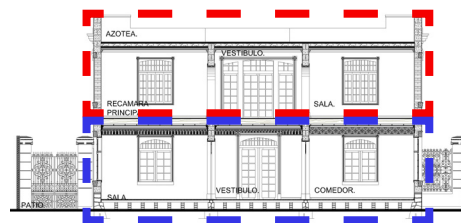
, corte longitudinal de Orizaba 146. En el nivel de planta baja se concentran todos los locales de uso público (marco azul), mientras que en planta alta están todos los locales de uso privado (marco rojo), las viviendas construidas durante la primera mitad de la década de 1920, se desarrollaban en uno, dos o hasta tres niveles por lo que no hay una zonificación específica para este tipo de viviendas.
